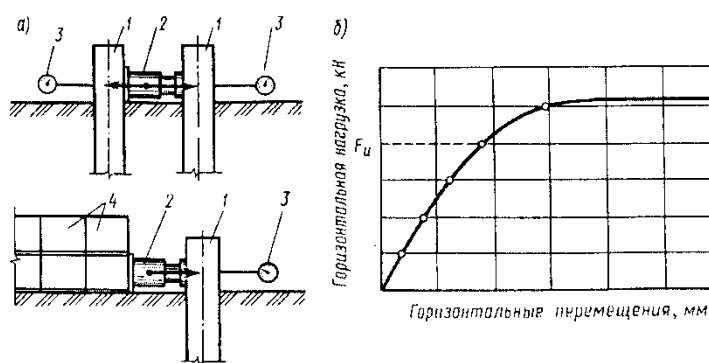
Испытания сваи горизонтальной нагрузкой:
